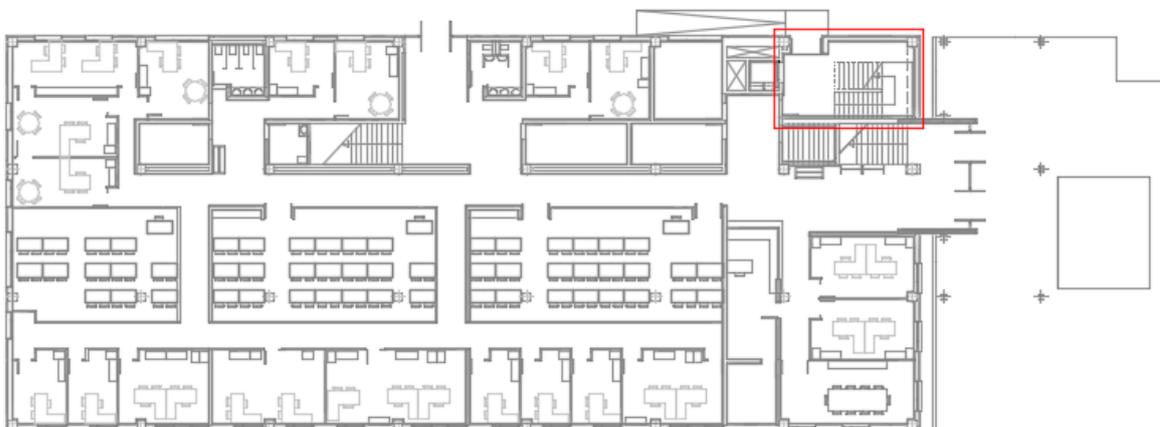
Cumplimiento Normativa escalera Planta Baja-Primera. Figura extraída del plano 32.
